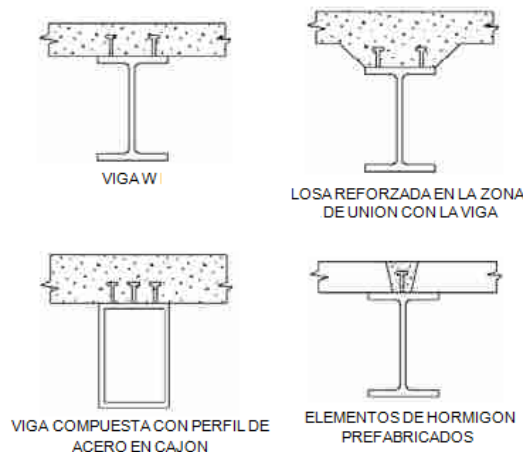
Formas embebidas de los conectores en el hormigón armado
